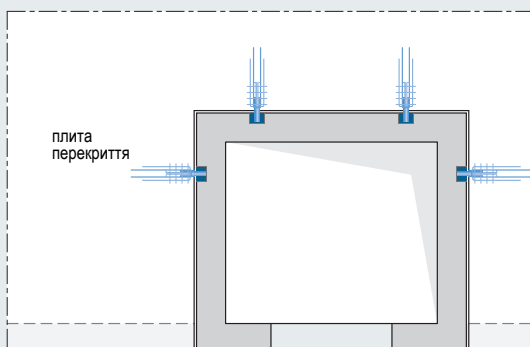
Опирання плит перекриття (наприклад, ліфтової шахти)
